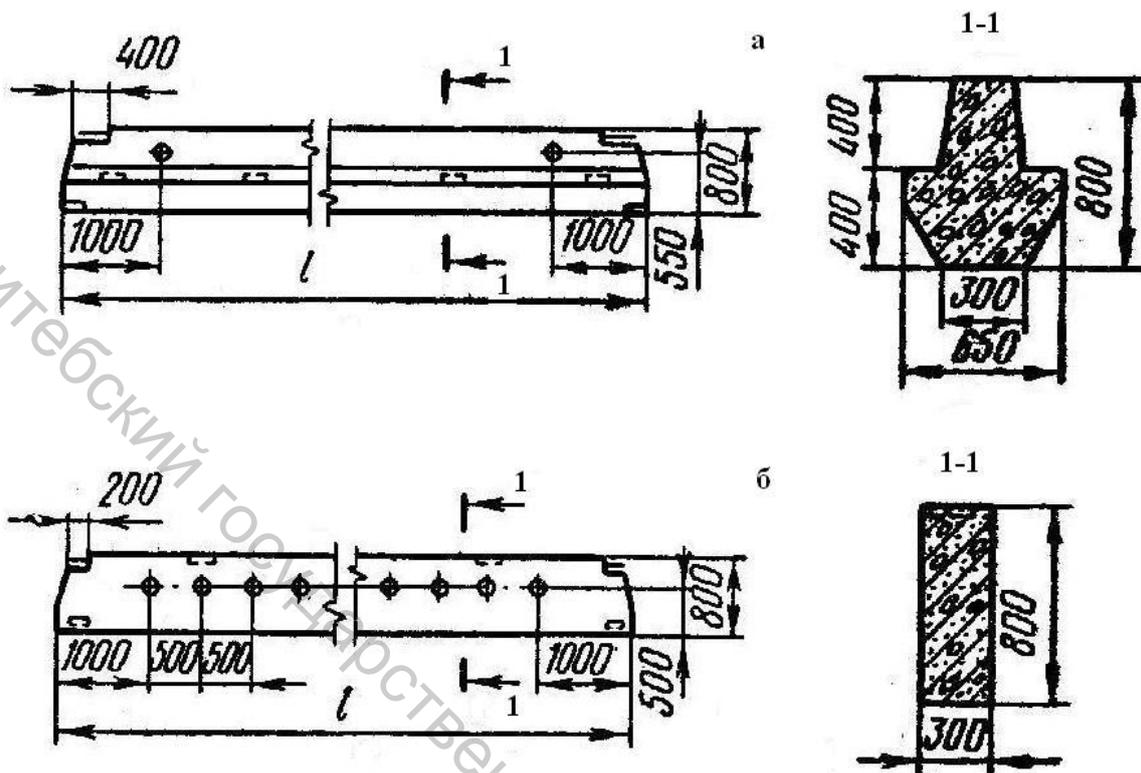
Ригели: I – ригели перекрытий пролётами 6, 9 и 12 м, II – ригели (а – для перекрытий типа «I», б – для перекрытий типа «II»)
